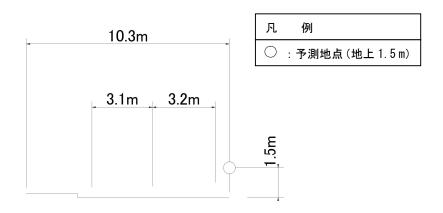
(6)予測断面図(F.一般県道沢渡高遠線沿道(伊那市東春近 7637-8 地先))
